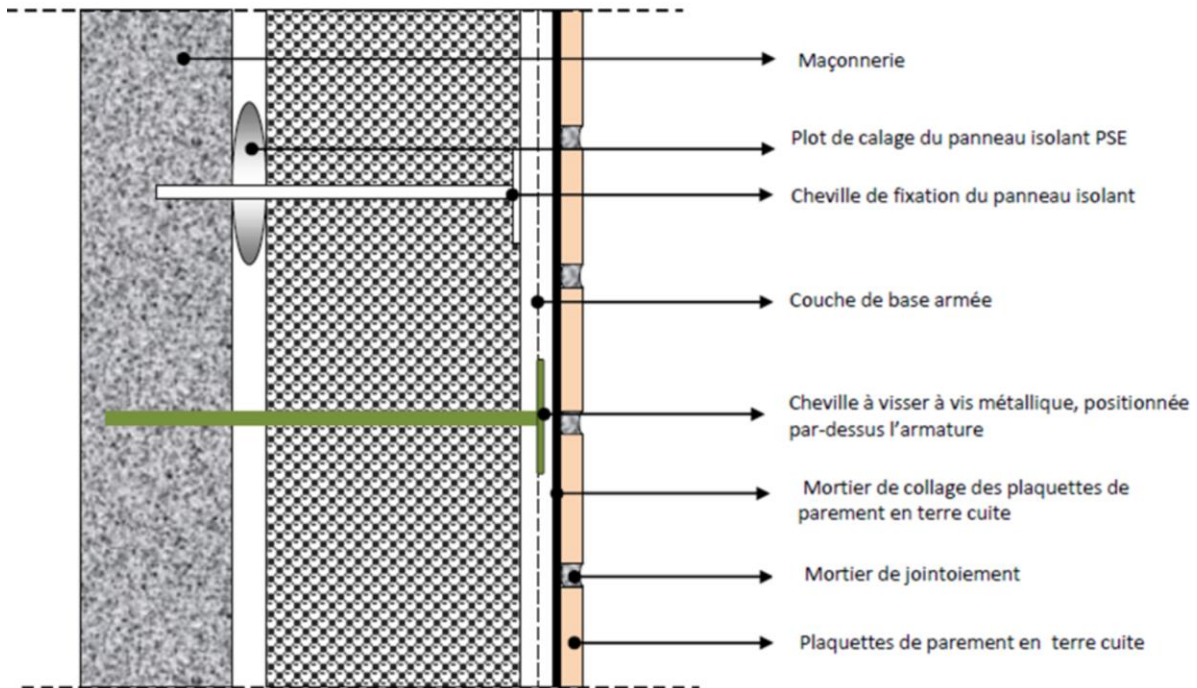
Principe du système Rhéatherm 600 LR avec finition « plaquette de parement en terre cuite »
